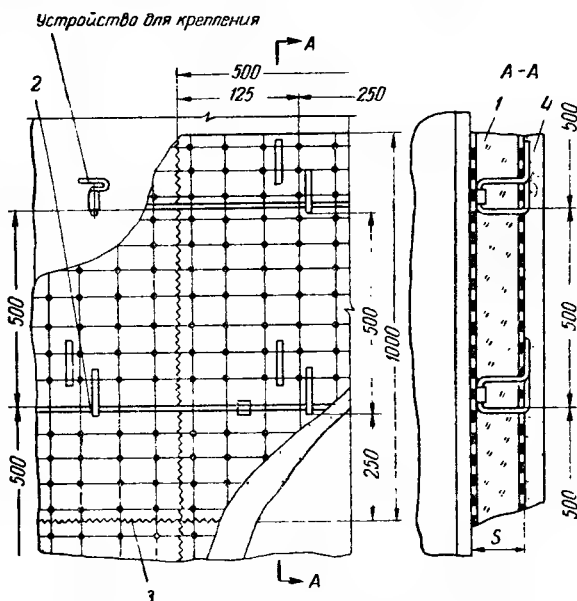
Изоляция листовой конструкции теплоизоляционными матами
